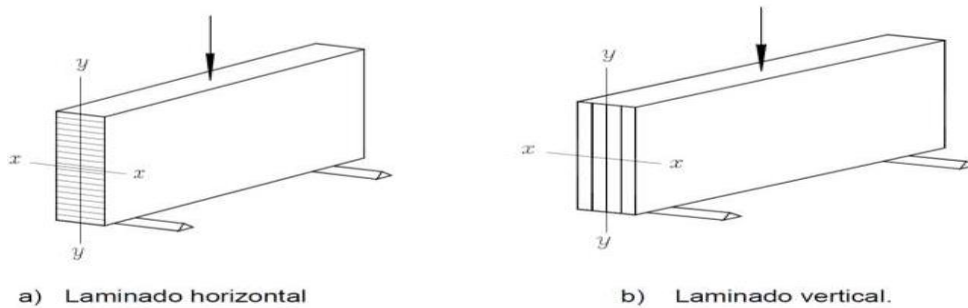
Tipos de laminados. Fuente: Curso calculo estructural en madera.
